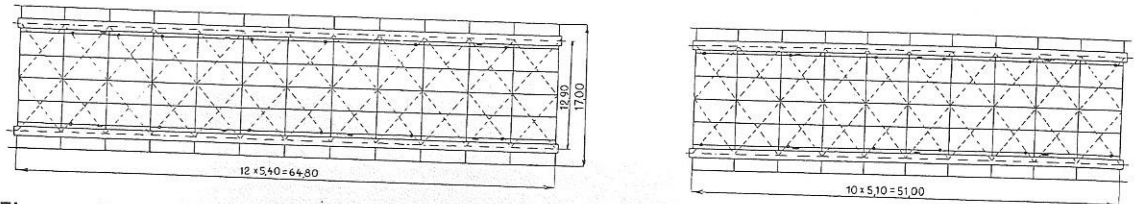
Vue en plan des deux ponts, montrant la disposition du contreventement inférieur. Les deux ponts sont réunis par un ponceau à poutre droite en béton.
